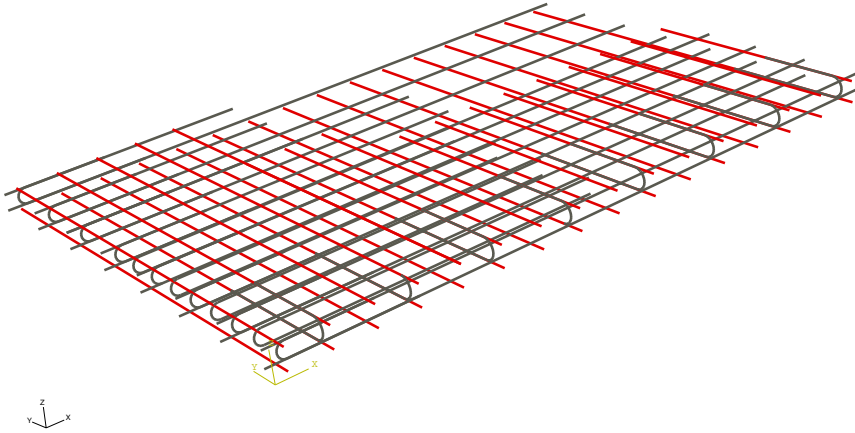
Mit Stabelementen diskretisierte Bewehrung
